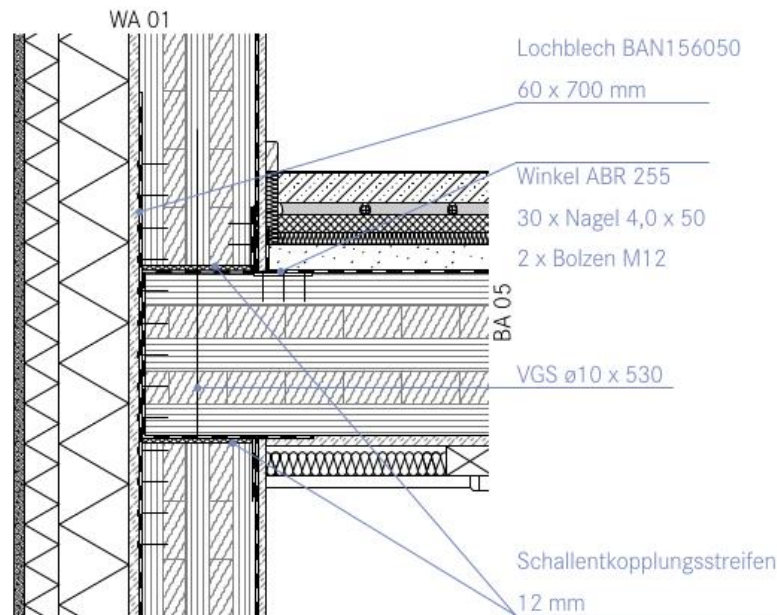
Detailplanung Fassadenstoß an Trenndecke der Brettsperrholzbauteile.
